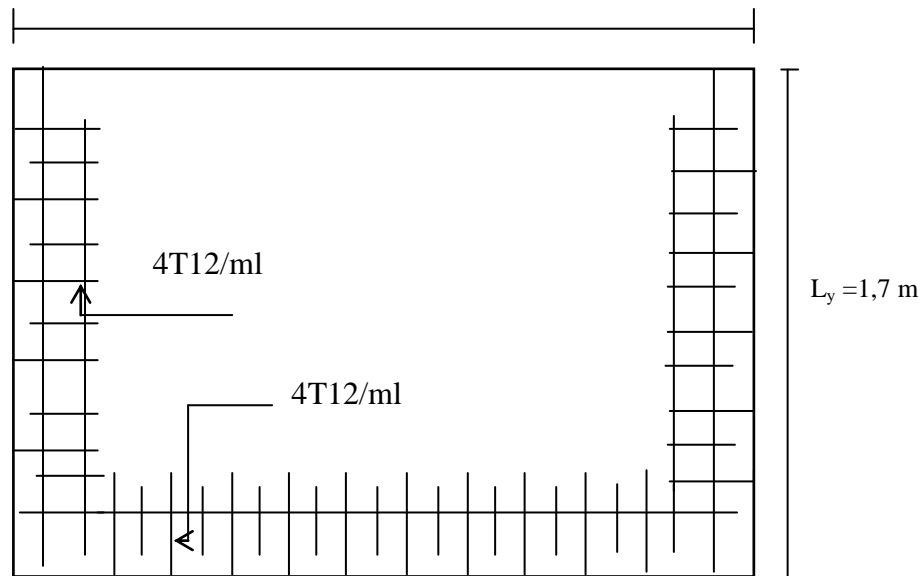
Ferrailage Supérieur du panneau de la dalle pleine.
